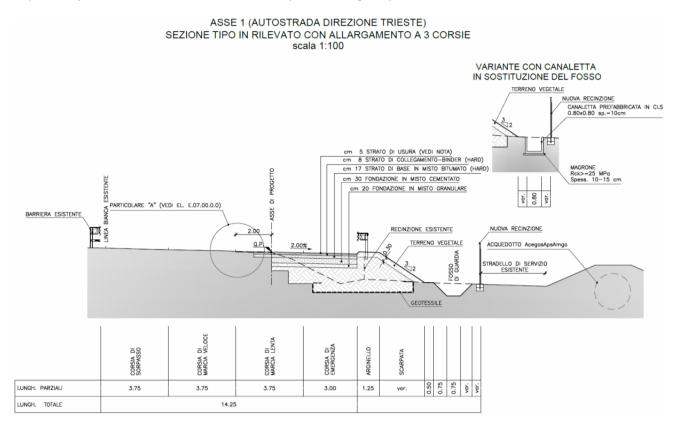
Estratto della tavola E.06.00.0.0 "Sezioni tipo", in cui è rappresentato il pacchetto di pavimentazione autostradale previsto in progetto.
